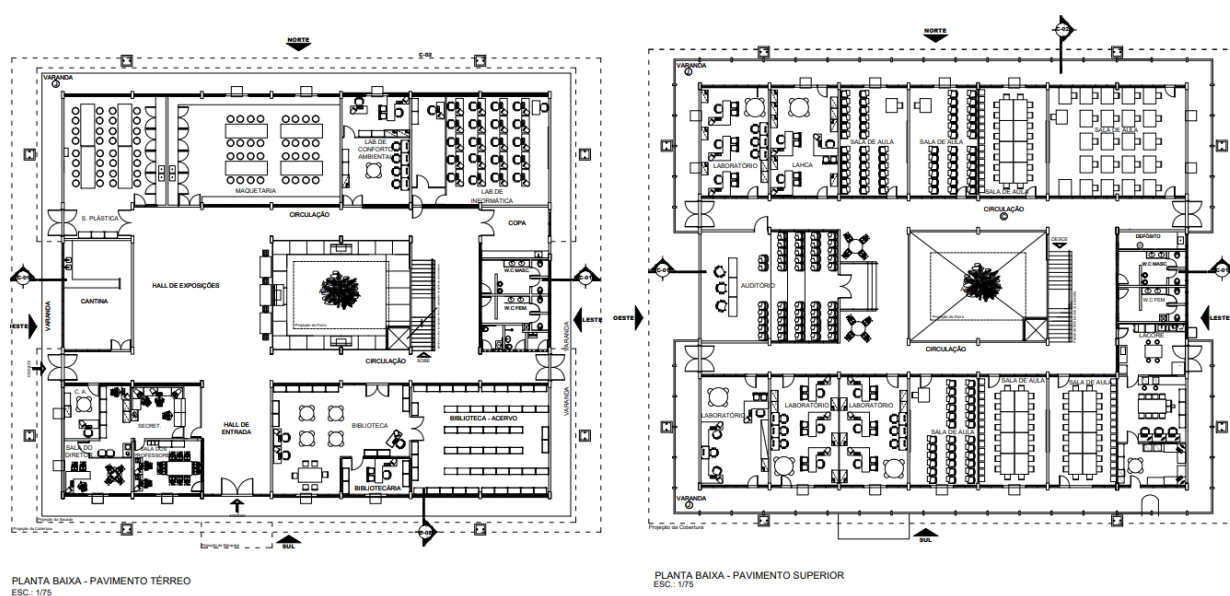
Planta Baixa do edifício antes da reforma de 2010.
